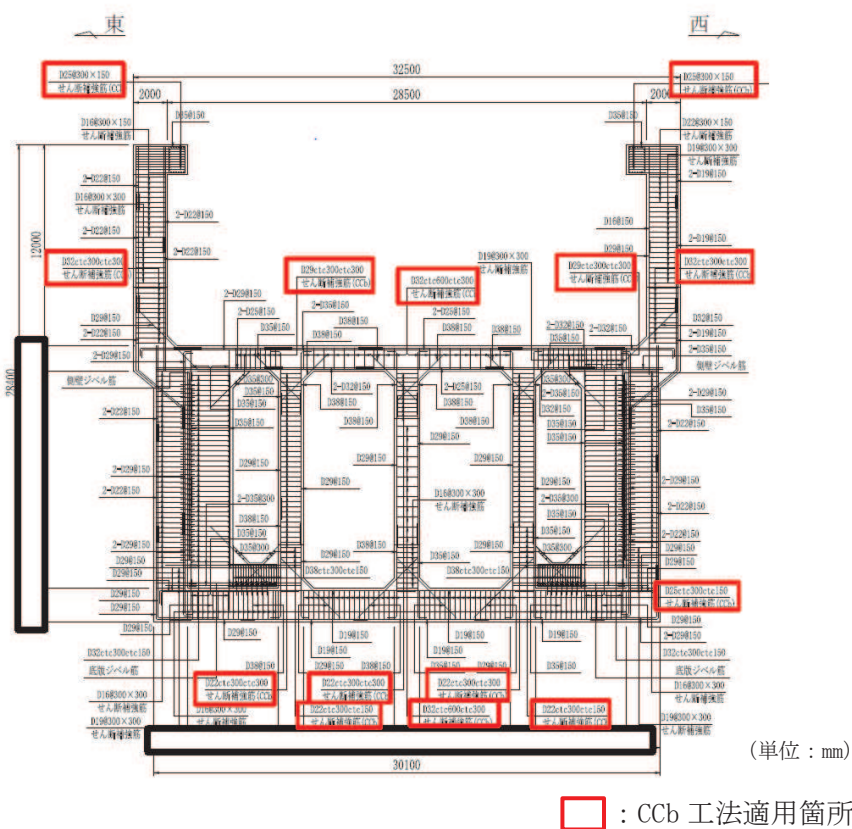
海水ポンプ室概略配筋図 (B-B 断面, 東西 (補機ポンプエリア))
